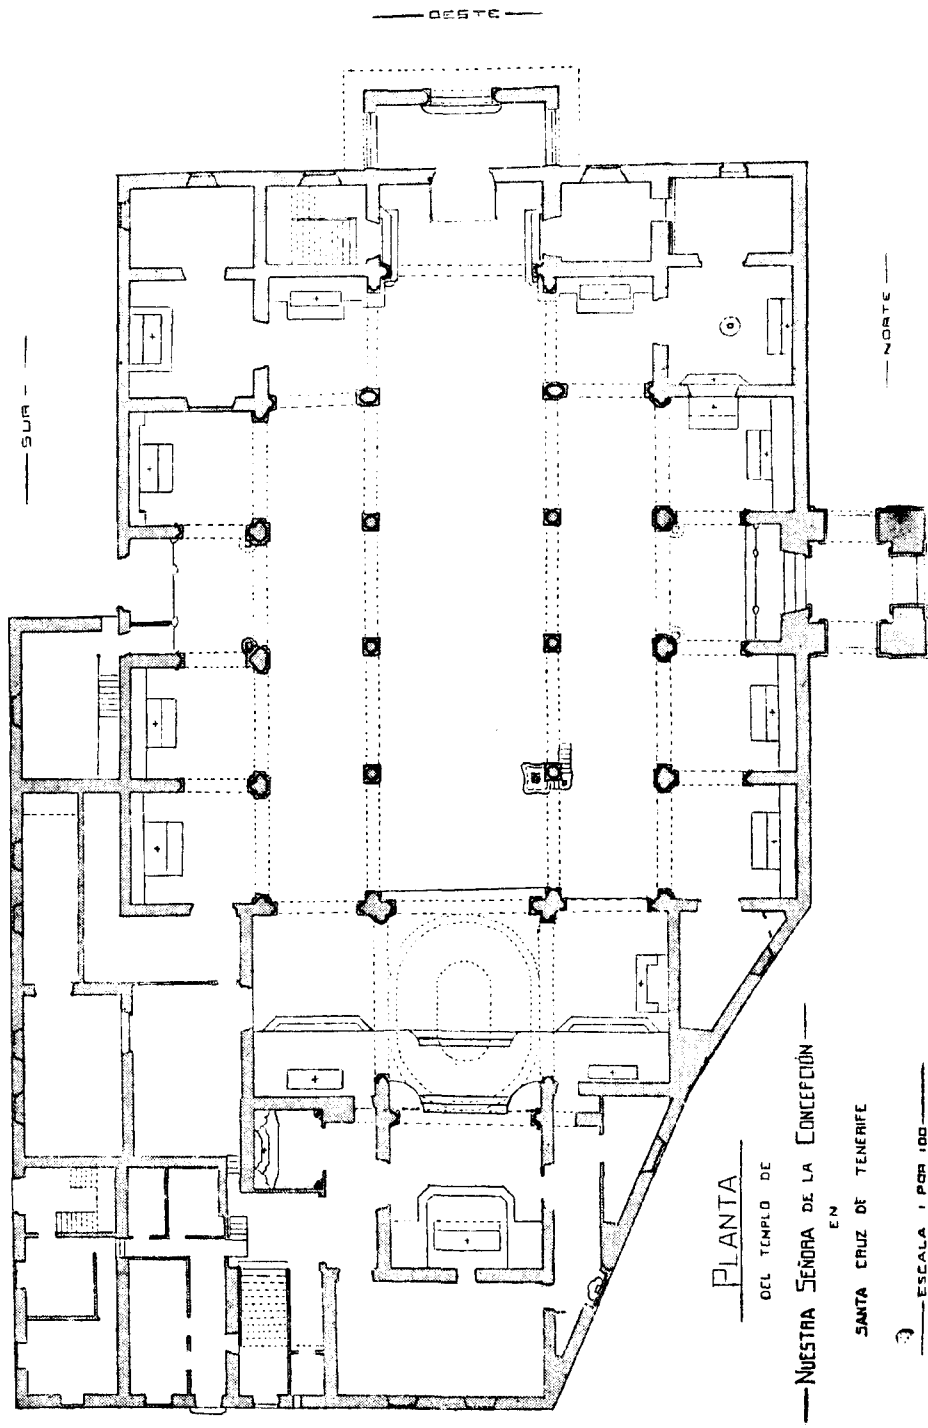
Planta de la parroquia de la Concepción. (Plano le don Arturo López de Vergara.)
